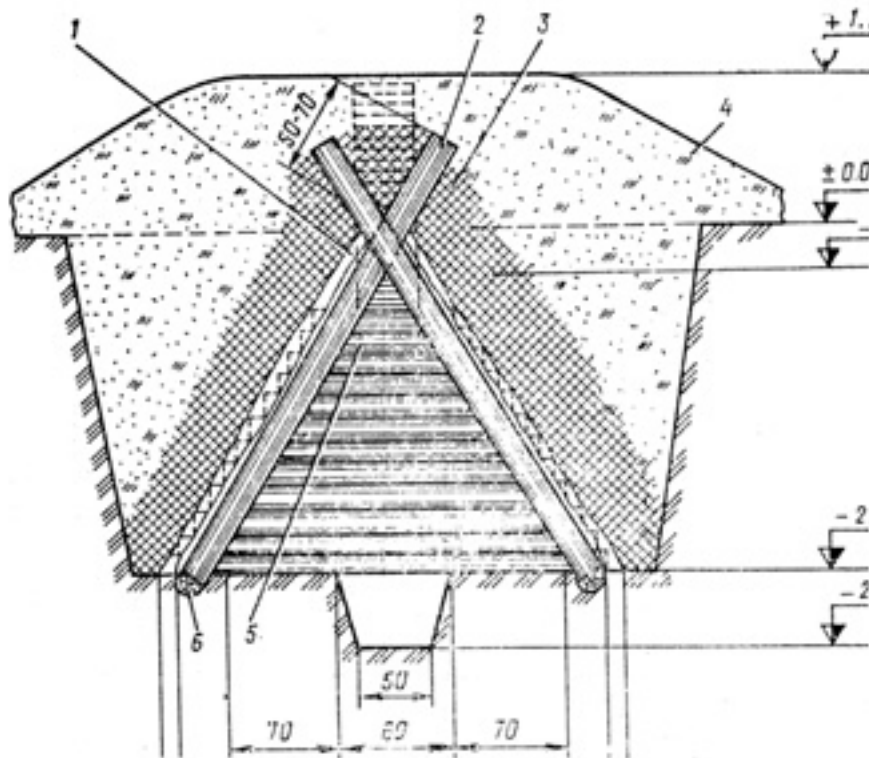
Быстровозводимое ПРУ: 1 – покрытие остова (гидроизоляция, ветки, лапник, солома и т.д.); 2 – бревно диаметром 10 см; 3 – плотно утрамбованный грунт; 4 – насыпной грунт; 5 – забирка; 6 – лежень
